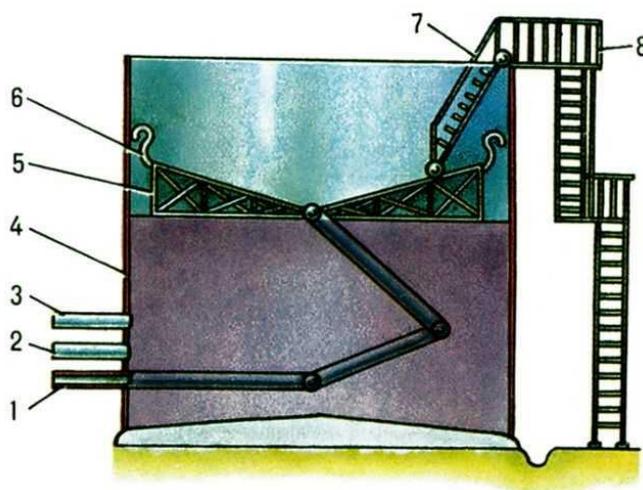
Схема резервуара с плавающей крышей: 1 - шарнирная труба для сброса ливневых вод с плавающей крыши; 2 - патрубок для отбора нефти; 3 - патрубок для подачи нефти; 4 - корпус резервуара; 5 - плавающая крыша; 6 - затвор, уплотняющий зазор между плавающей крышей и корпусом; 7 - лестница для осмотра крыш; 8 - маршевая лестница
